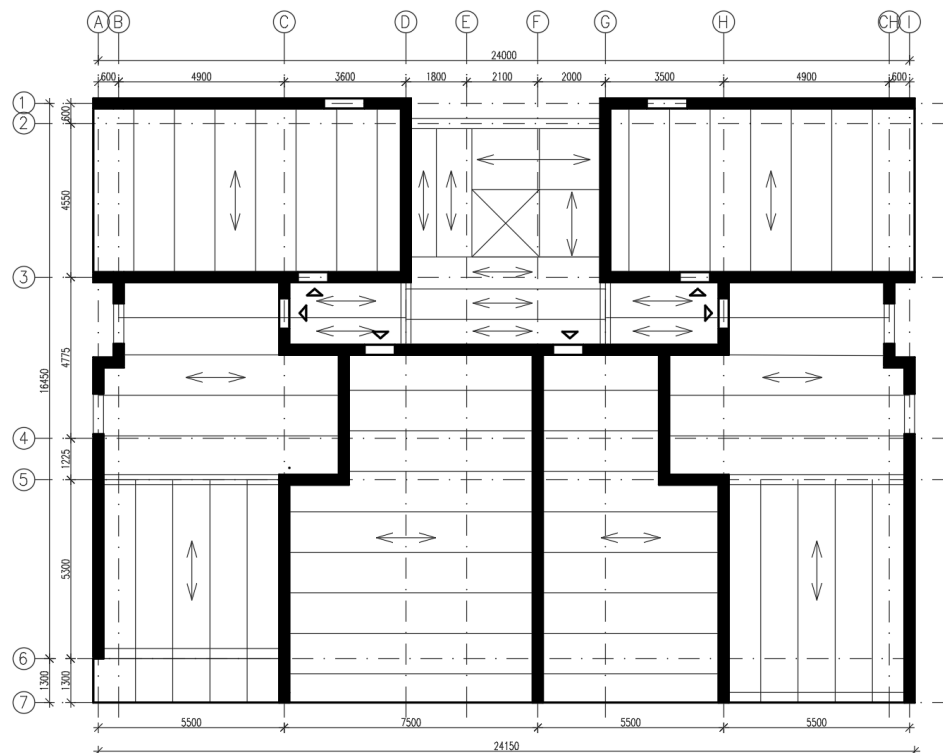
Konstrukční schéma 1. NP – Varianta 2
